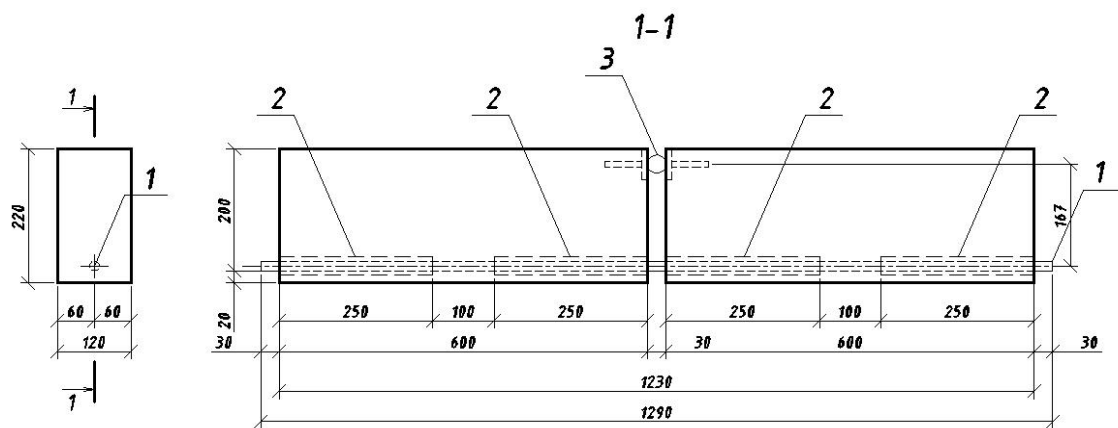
Конструкція дослідного зразка - бетонної балки:
